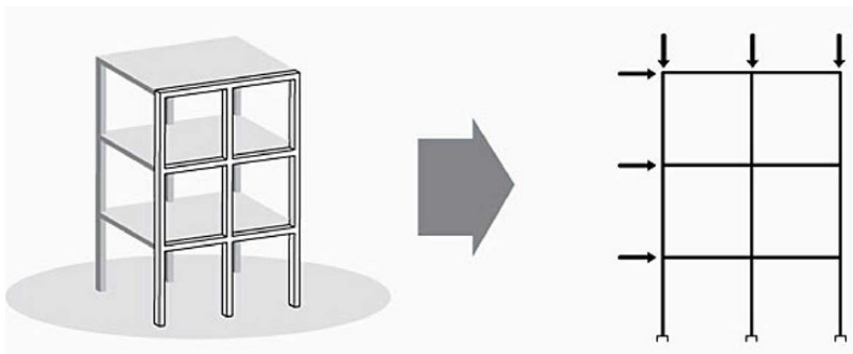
Modelo de pórtico plano (KIMURA, 2007)
